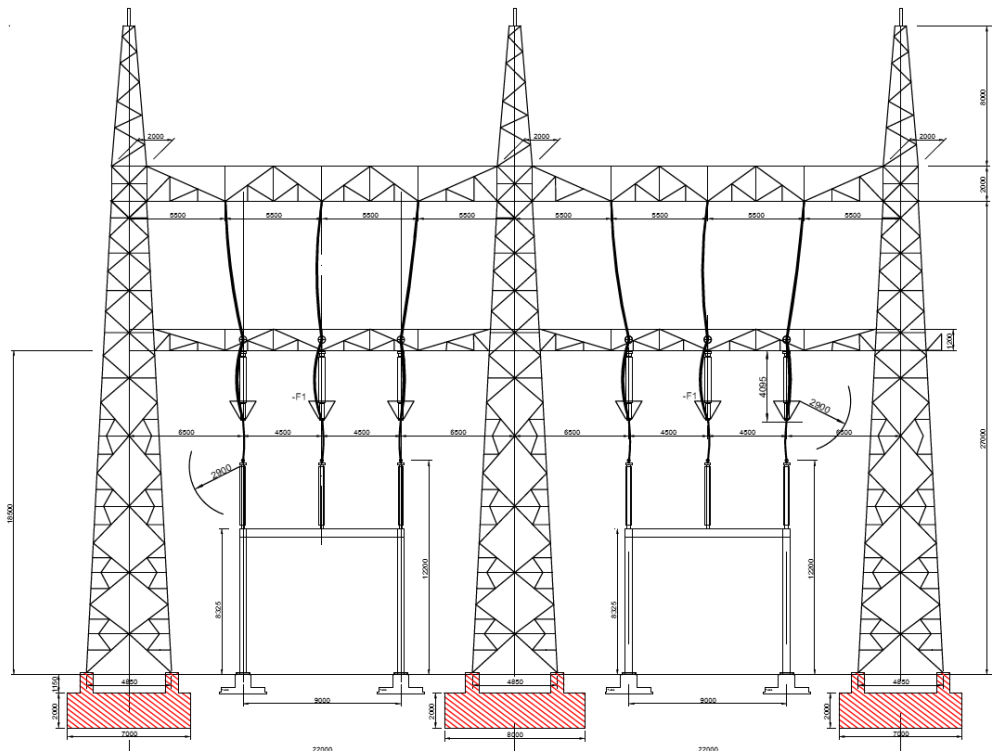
Kabelübergangsanlage, exemplarische Darstellung (Grundriss)
